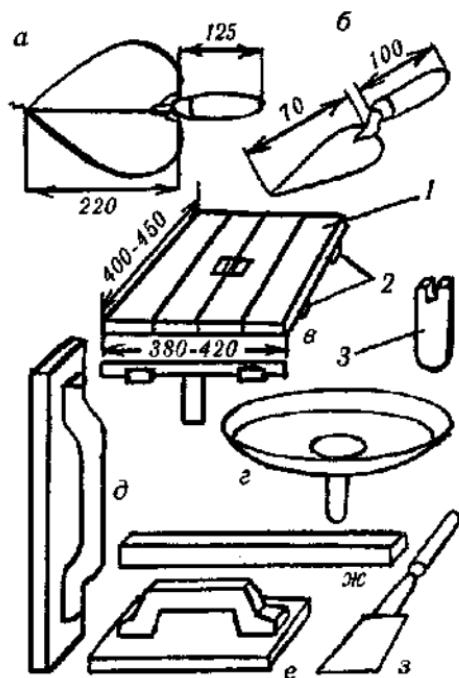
Штукатурный инструмент: а — кельма; б — отрезовка, в — скокол деревянный; г — скокол металлический; д — полутерок; е — терка; ж — правило; з — скребок; I — щит скокола; 2 — шпонки; 3 — ручка скокола.
